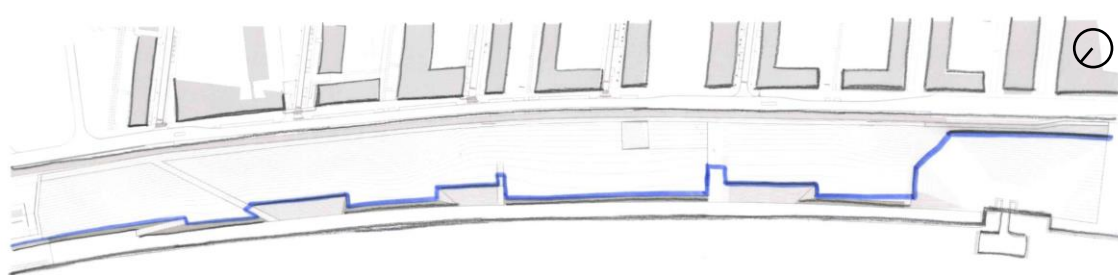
Plano esquemático – estrutura longitudinal, linha de cota 9,5 m
